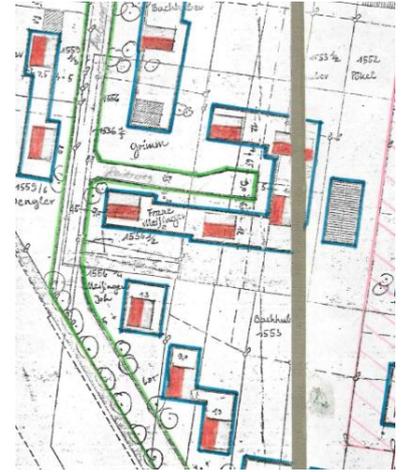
Ausschnitt Baulinienplan Nr. 52, ohne Maßstab
